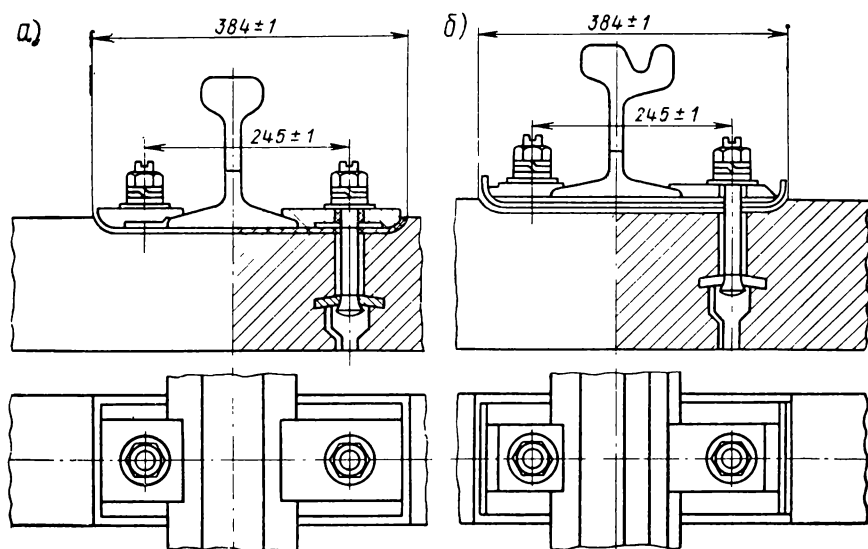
Промежуточные крепления для трамвайных железобетонных шпал:
